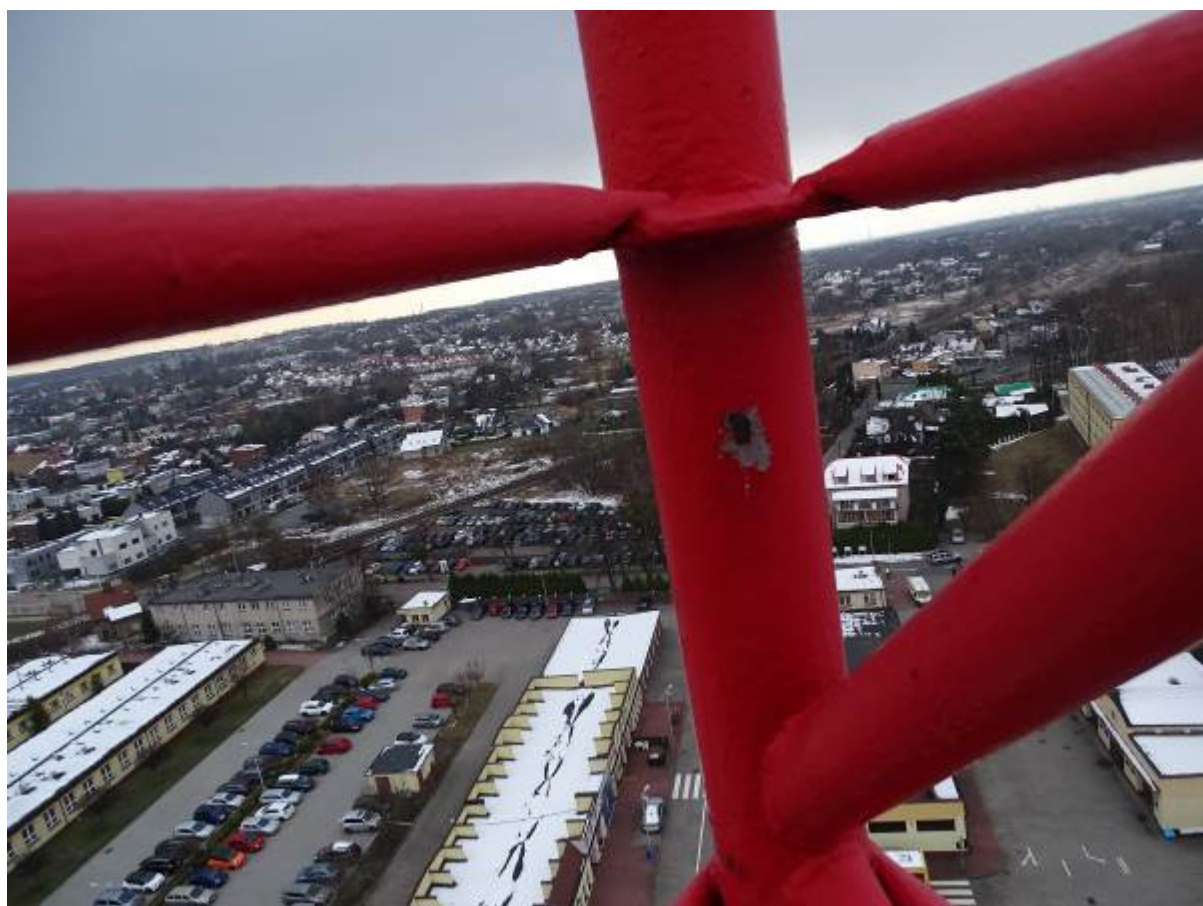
Konstrukcja wsporcza oświetlenia – korozja łączników
